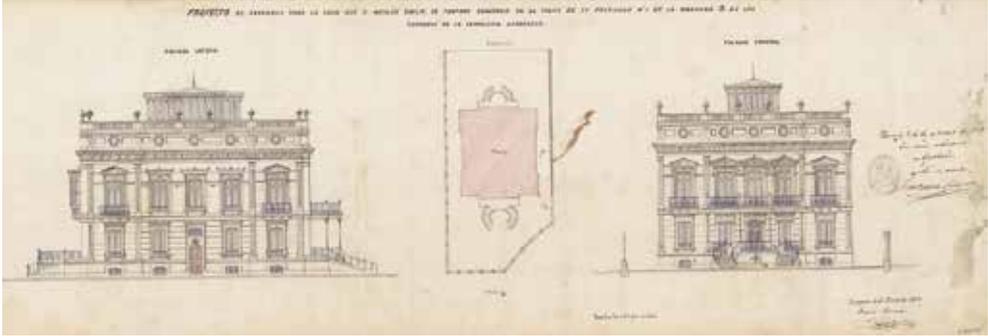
Proyecto de fachadas (principal y lateral) y de planta para la casa que D. Nicolás Baylin se propone construir en el solar de su propiedad n.º 1 situado en la manzana D de los terrenos de la Exposición Aragonesa –plaza de Aragón, n.º 1–, por el maestro de obras Antonio Miranda, 11 de enero de 1879 (Archivo Municipal de Zaragoza).
